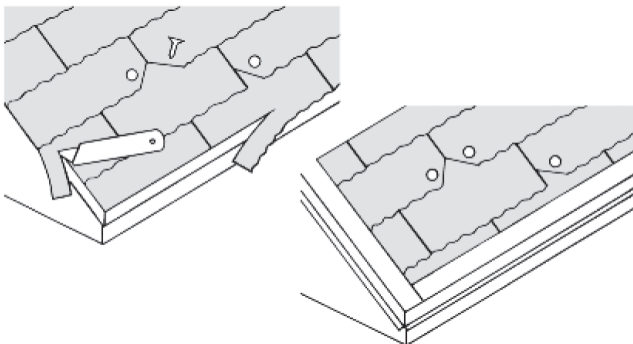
Подготовка старой кровли к укладке нового гонта.
